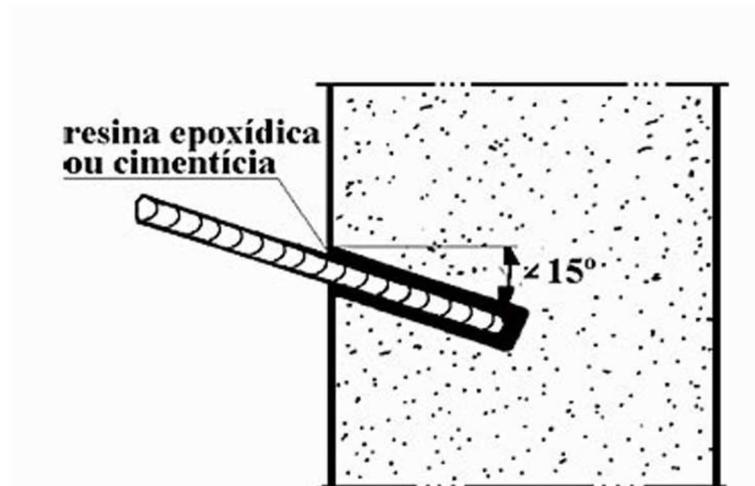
Ancoragem de barras à flexão, com enchimento da furação por gravidade (SOUZA, 1998)
